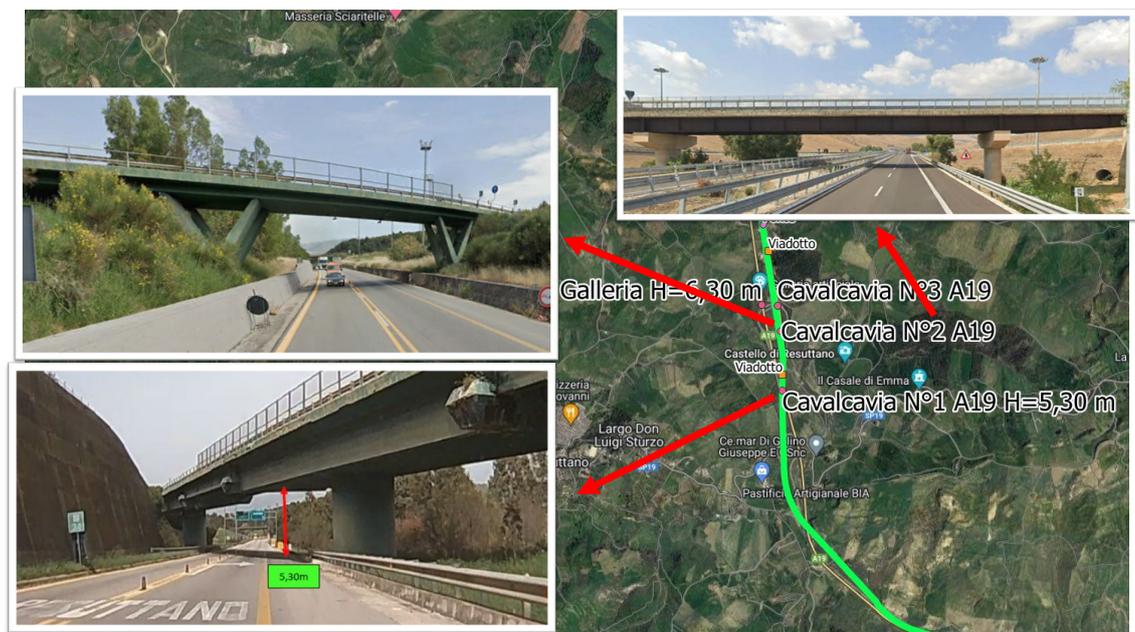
Elemento critico Cavalcavia A19-1 e cavalcavia A19-2 e A19-3.
